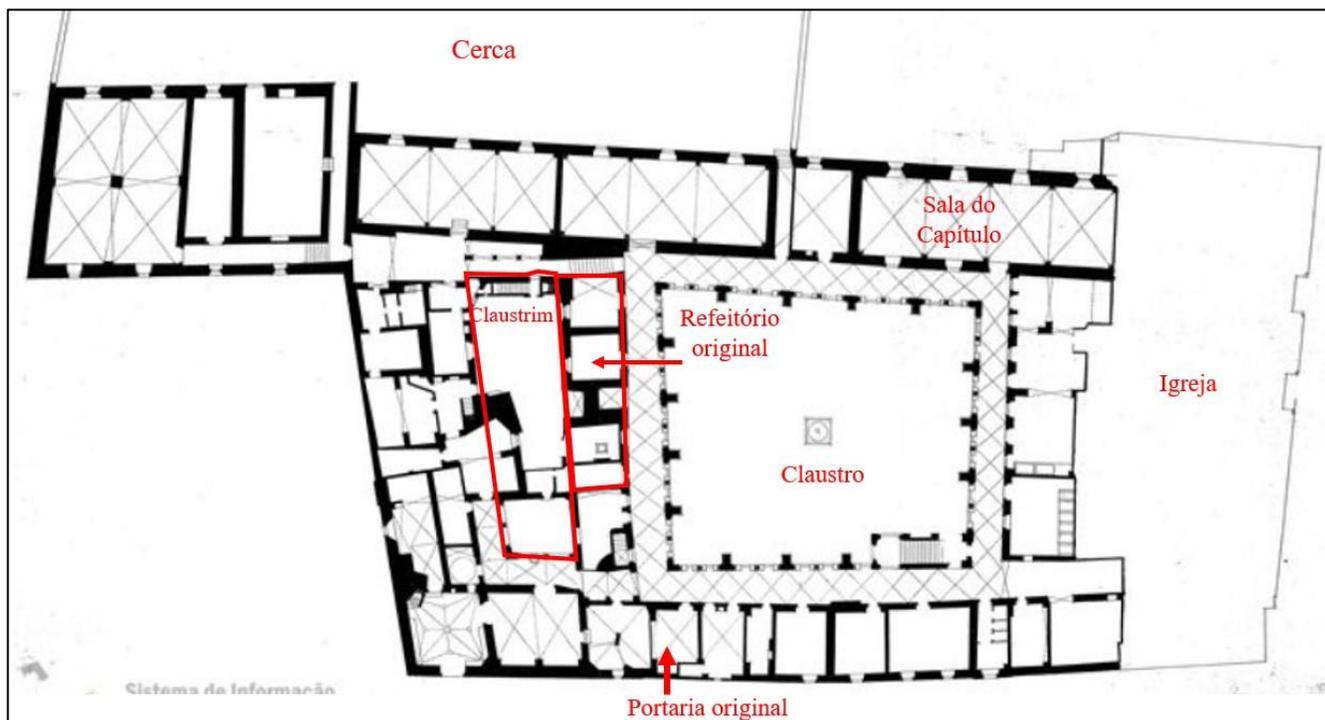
Planta do primeiro piso do Convento de Santa Clara.
